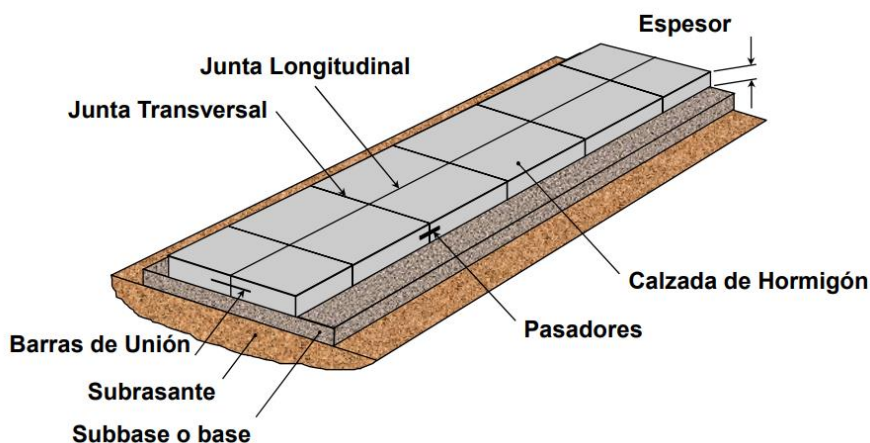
Estructura tradicional de pavimento rígido [33]
